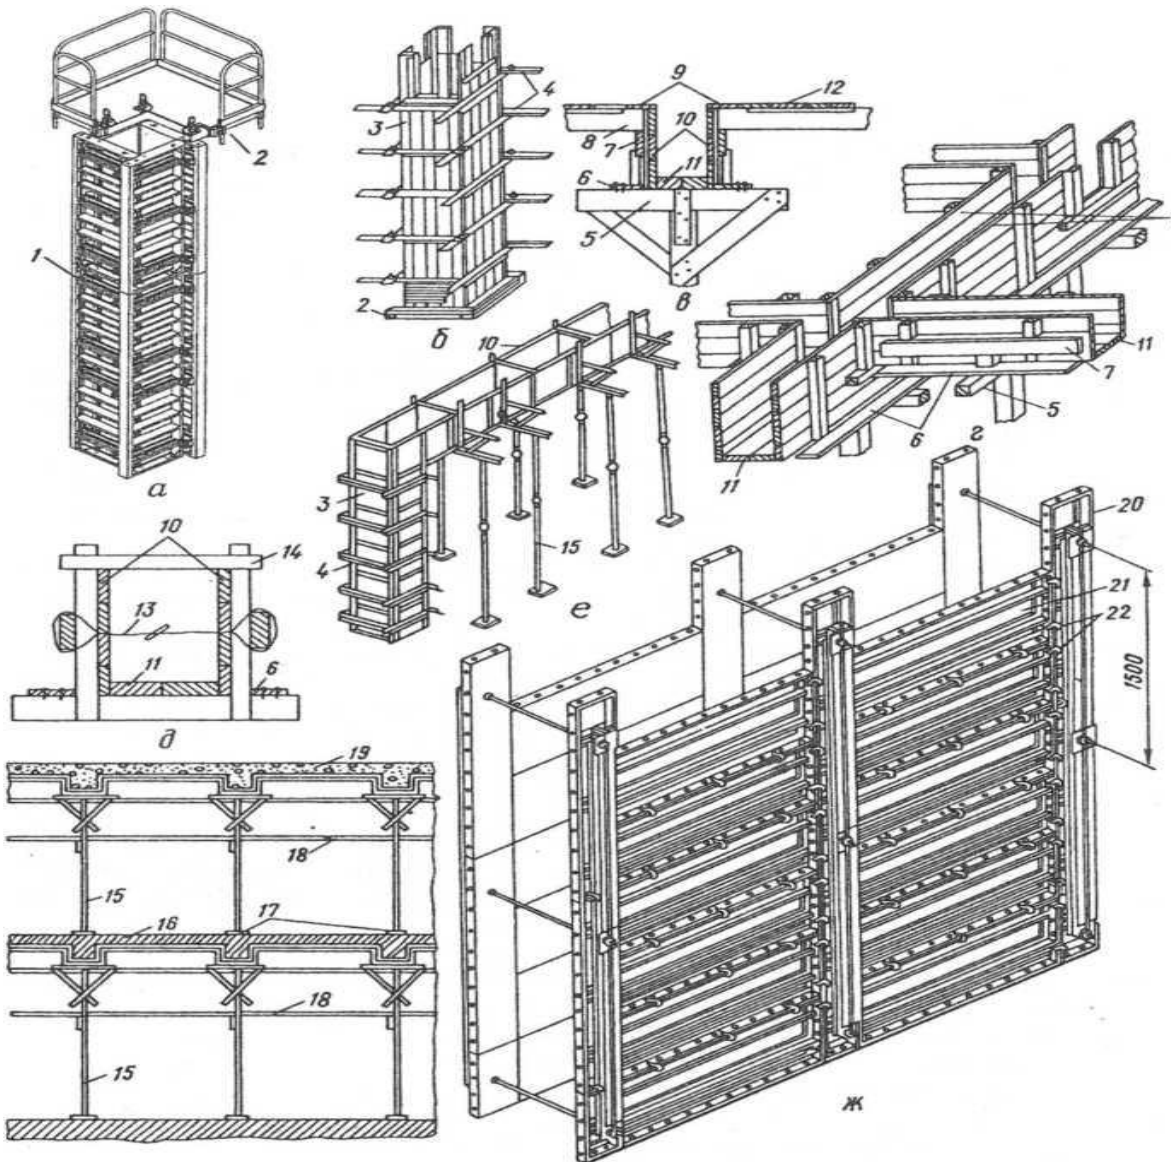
Опалубка колон, ребристого перекриття, прогонів і стін:
